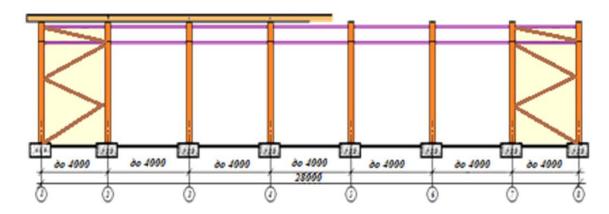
Схемы установкивертикальных связей по длине здания
